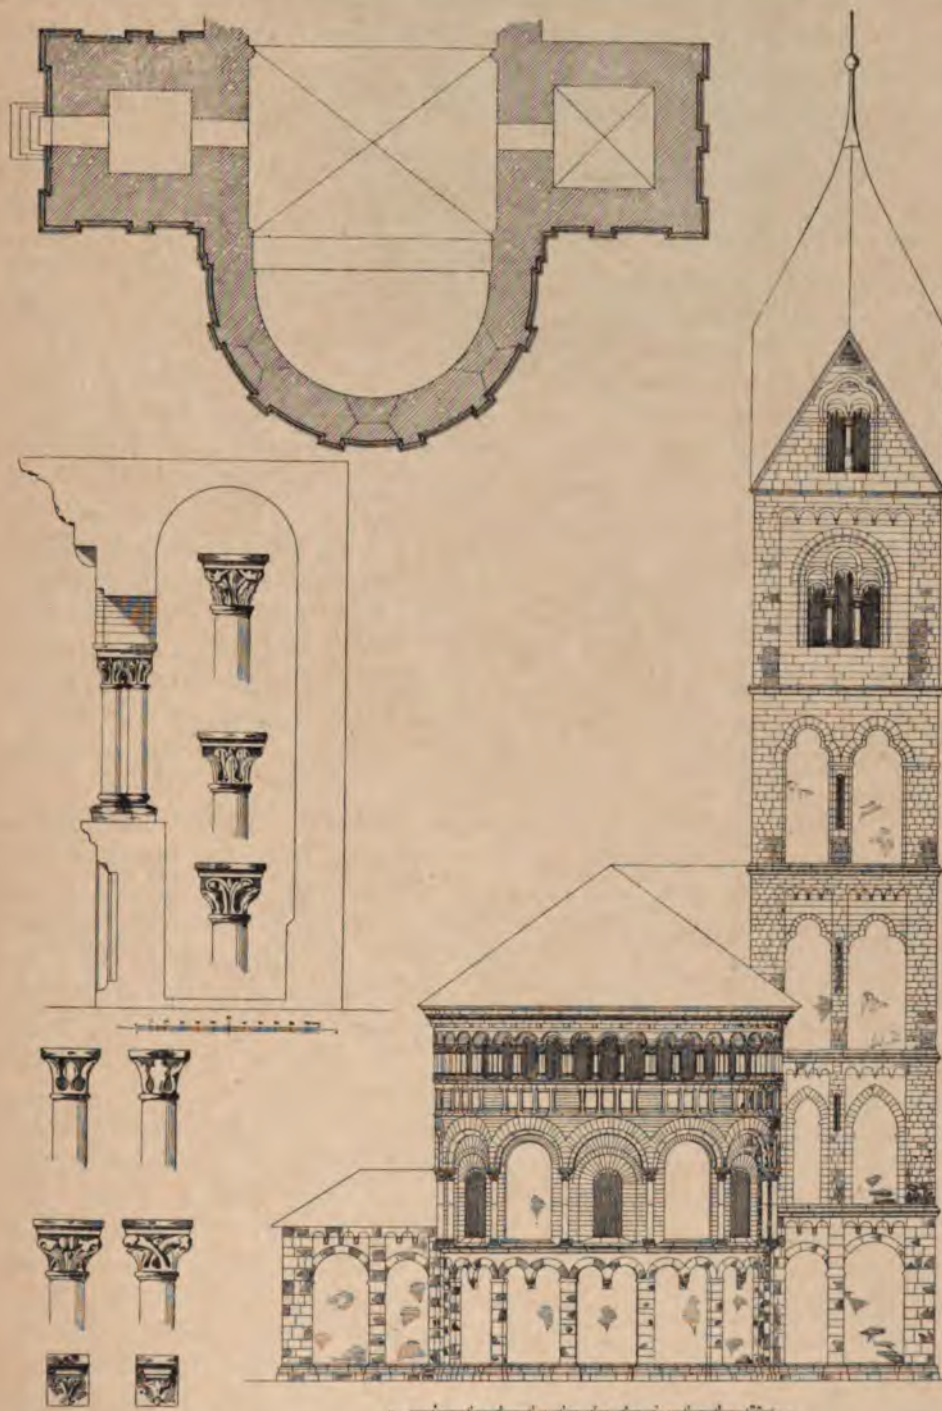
Lonnig, kathol. Pfarrkirche. Grundriss, Aufriss des Chores und Details der Zwerggalerie.
